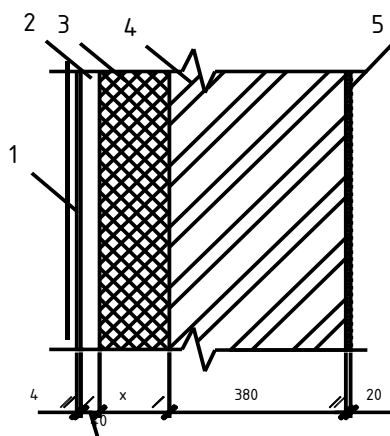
Сечение стены. 1 – вентилируемый фасад «Alucobond»; 2- воздушная прослойка; 3- минераловатная плита «ВЕНТИ БАТТС»; 4- кирпичная кладка; 5- цементно-песчаный раствор.
